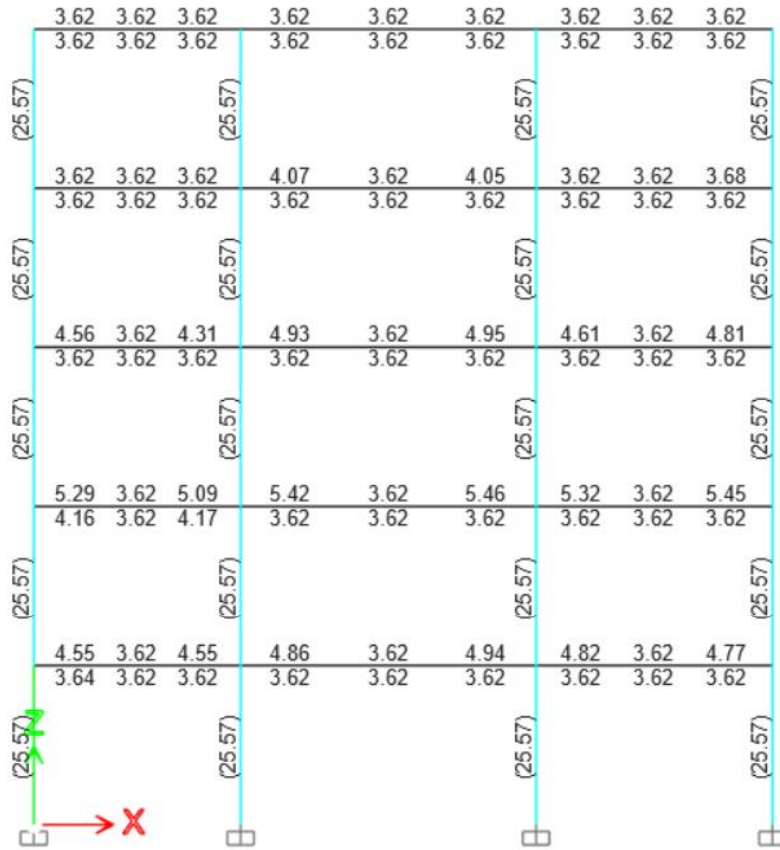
Refuerzo Longitudinal Columnas cm^2 - Estructura 5 Pisos
